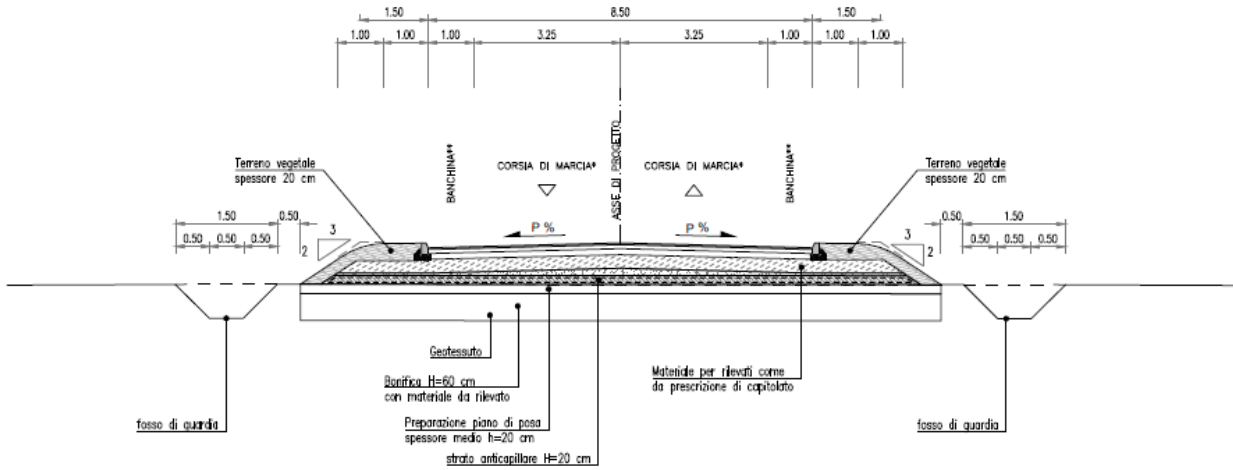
Sezione Tipo Ramo di svincolo in rettilo – cat F2
